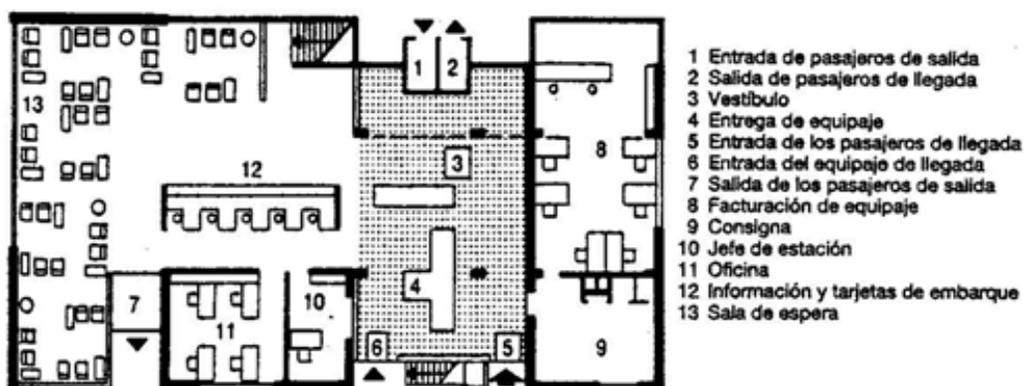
Planta baja de una estación de autobuses. Fuente: (Neufert, 2009)
